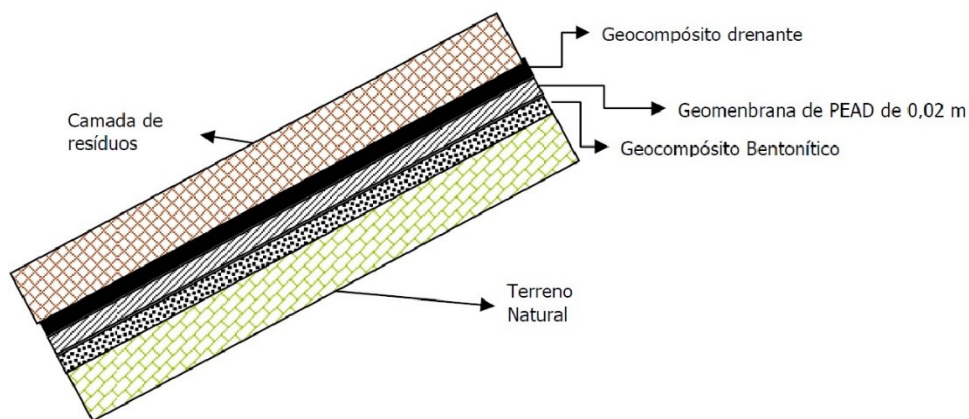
Pormenor do sistema de impermeabilização dos taludes basais de um aterro sanitário (Santos, 2008)
